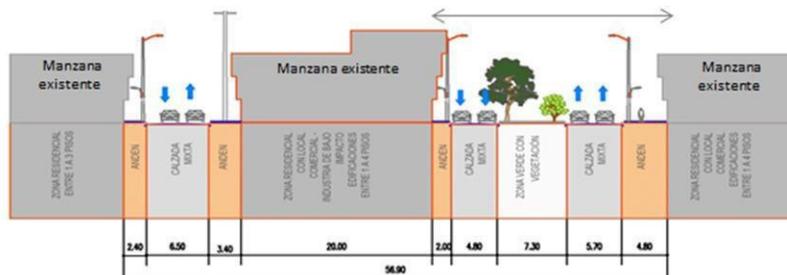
Perfil tipo existente tramo 2 desde el Rio Tunjuelito a la Calle 43ª sur
